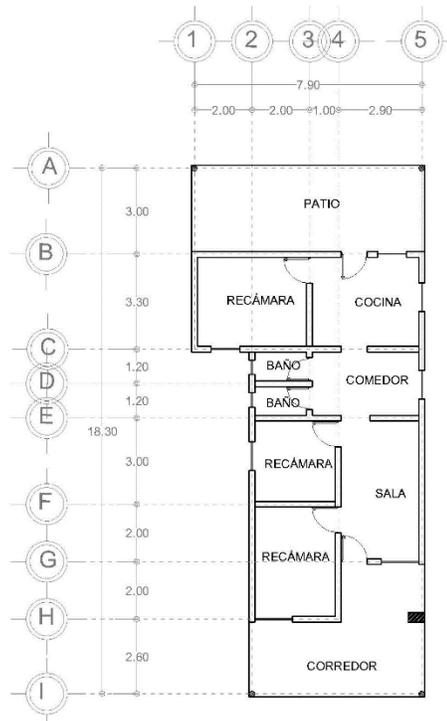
Planta arquitectónica tipología de vivienda en Tabasco. Fuente: propia.
